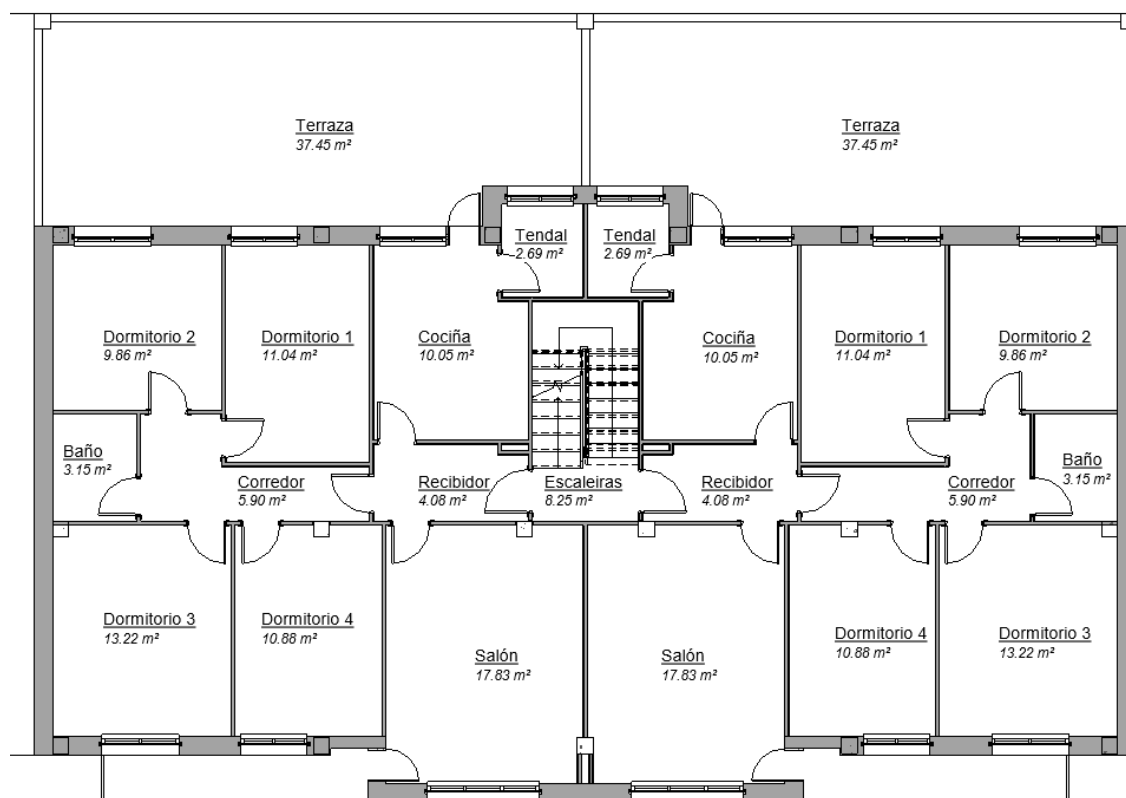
Distribución interior das vivendas do primeiro andar.
